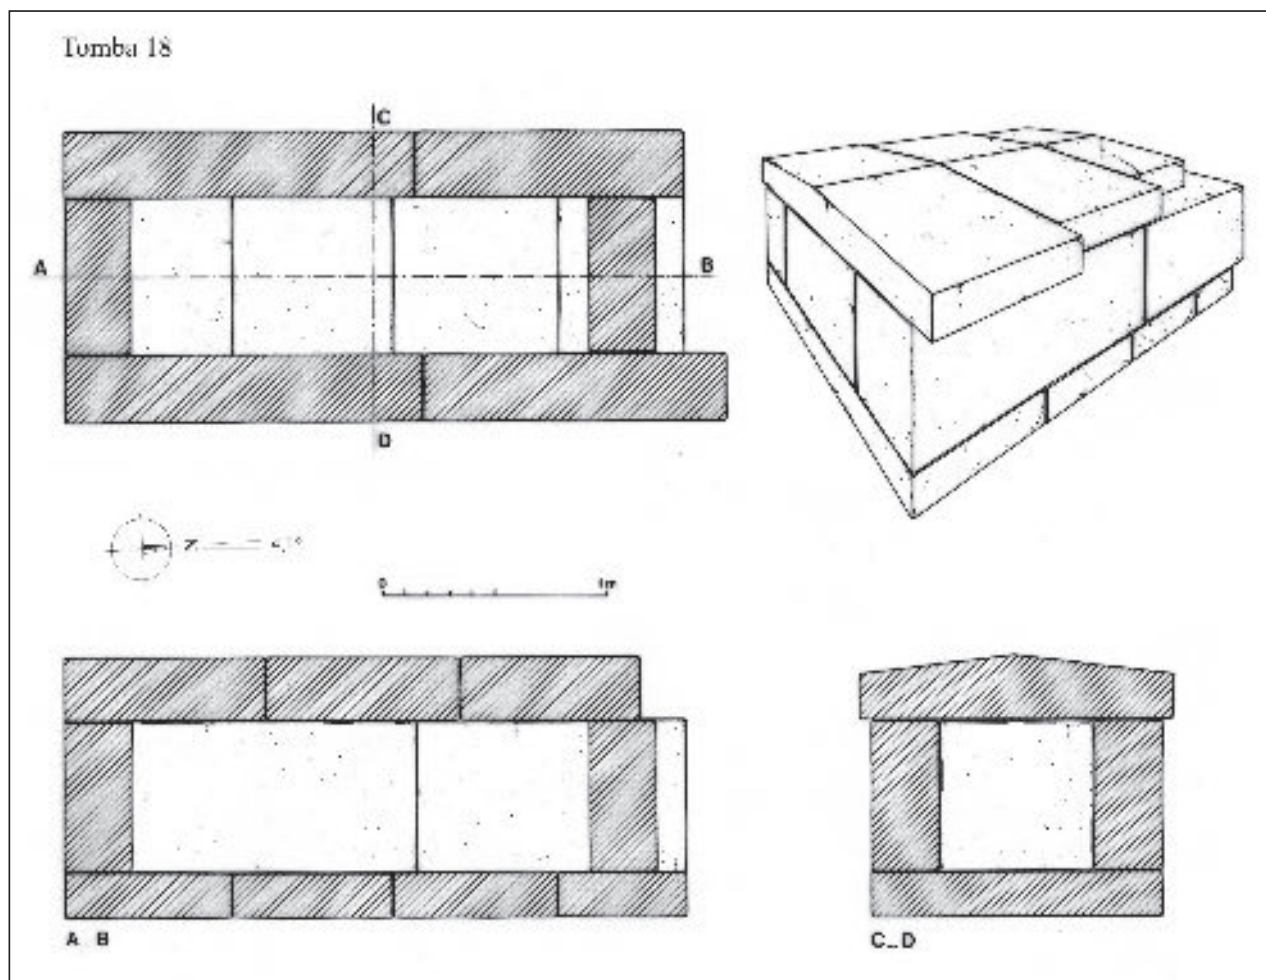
La tomba 18: pianta, assonometria e sezioni.
